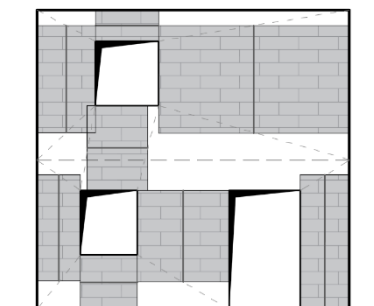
Discretizzazione della parete muraria in elementi strutturali.
